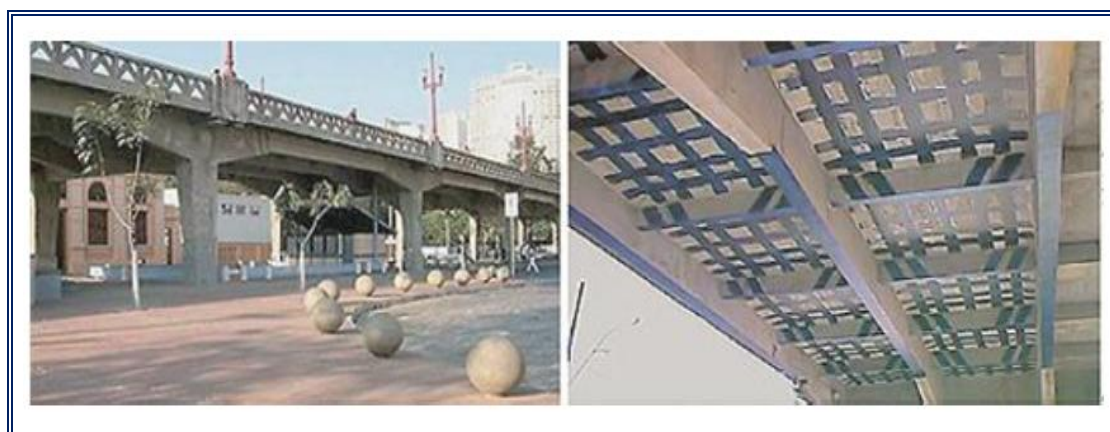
REFORÇO COM PRFC NO VIADUTO SANTA TEREZA, BELO HORIZONTE - MG.
